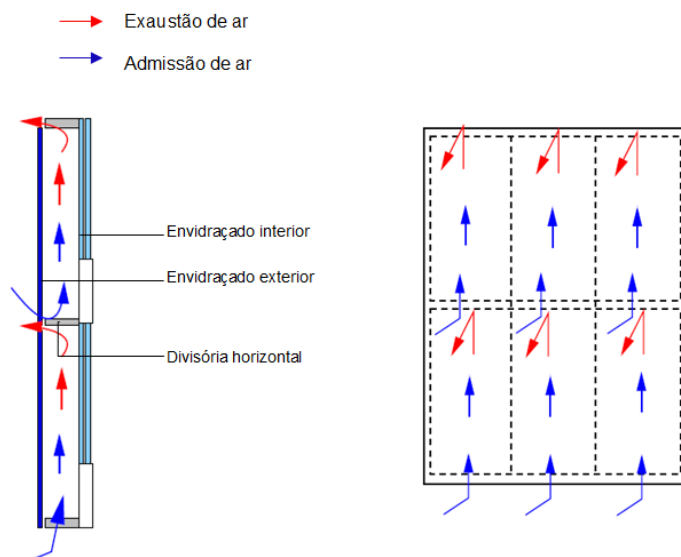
Geometria e esquema geral de ventilação de uma fachada do tipo “Corredor” (vista frontal e corte em perfil) (adaptado de Faggembau, 2006).
